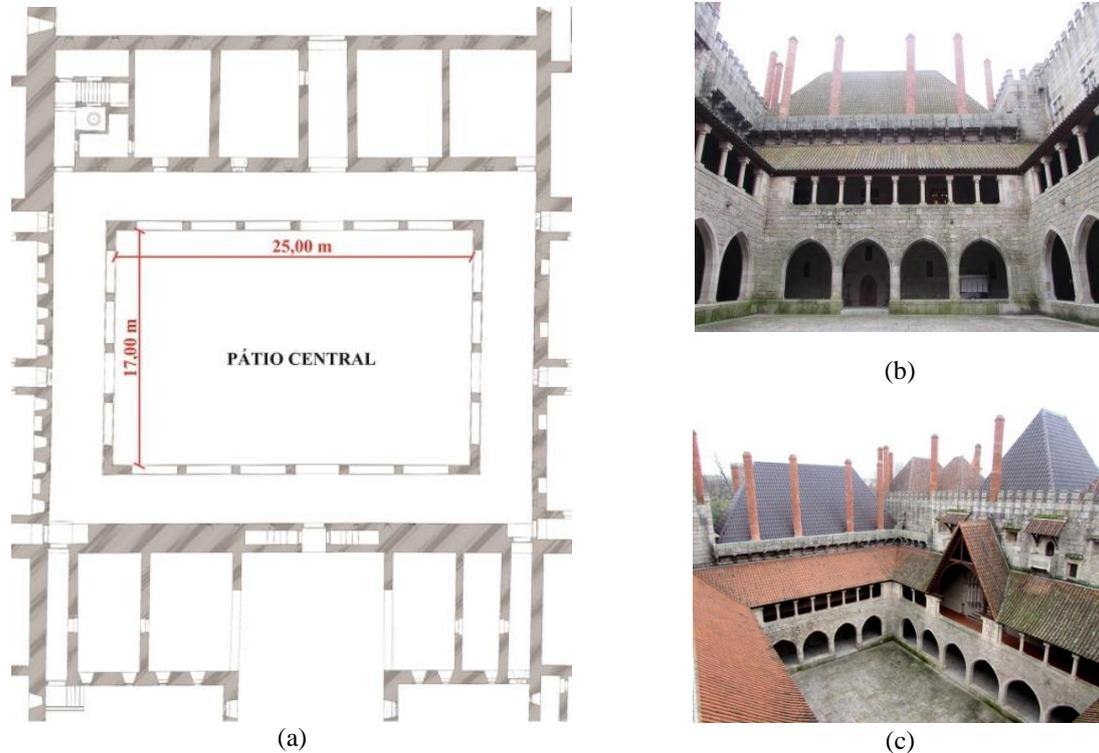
(a) Planta com as dimensões do pátio central; (b) Vista do pátio central para o claustro; (c) Vista geral do pátio central.
